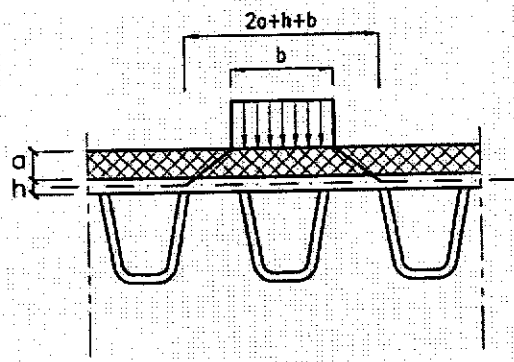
Diffusione dei carichi concentrati attraverso la pavimentazione e gli impalcati a piastra ortotropa
